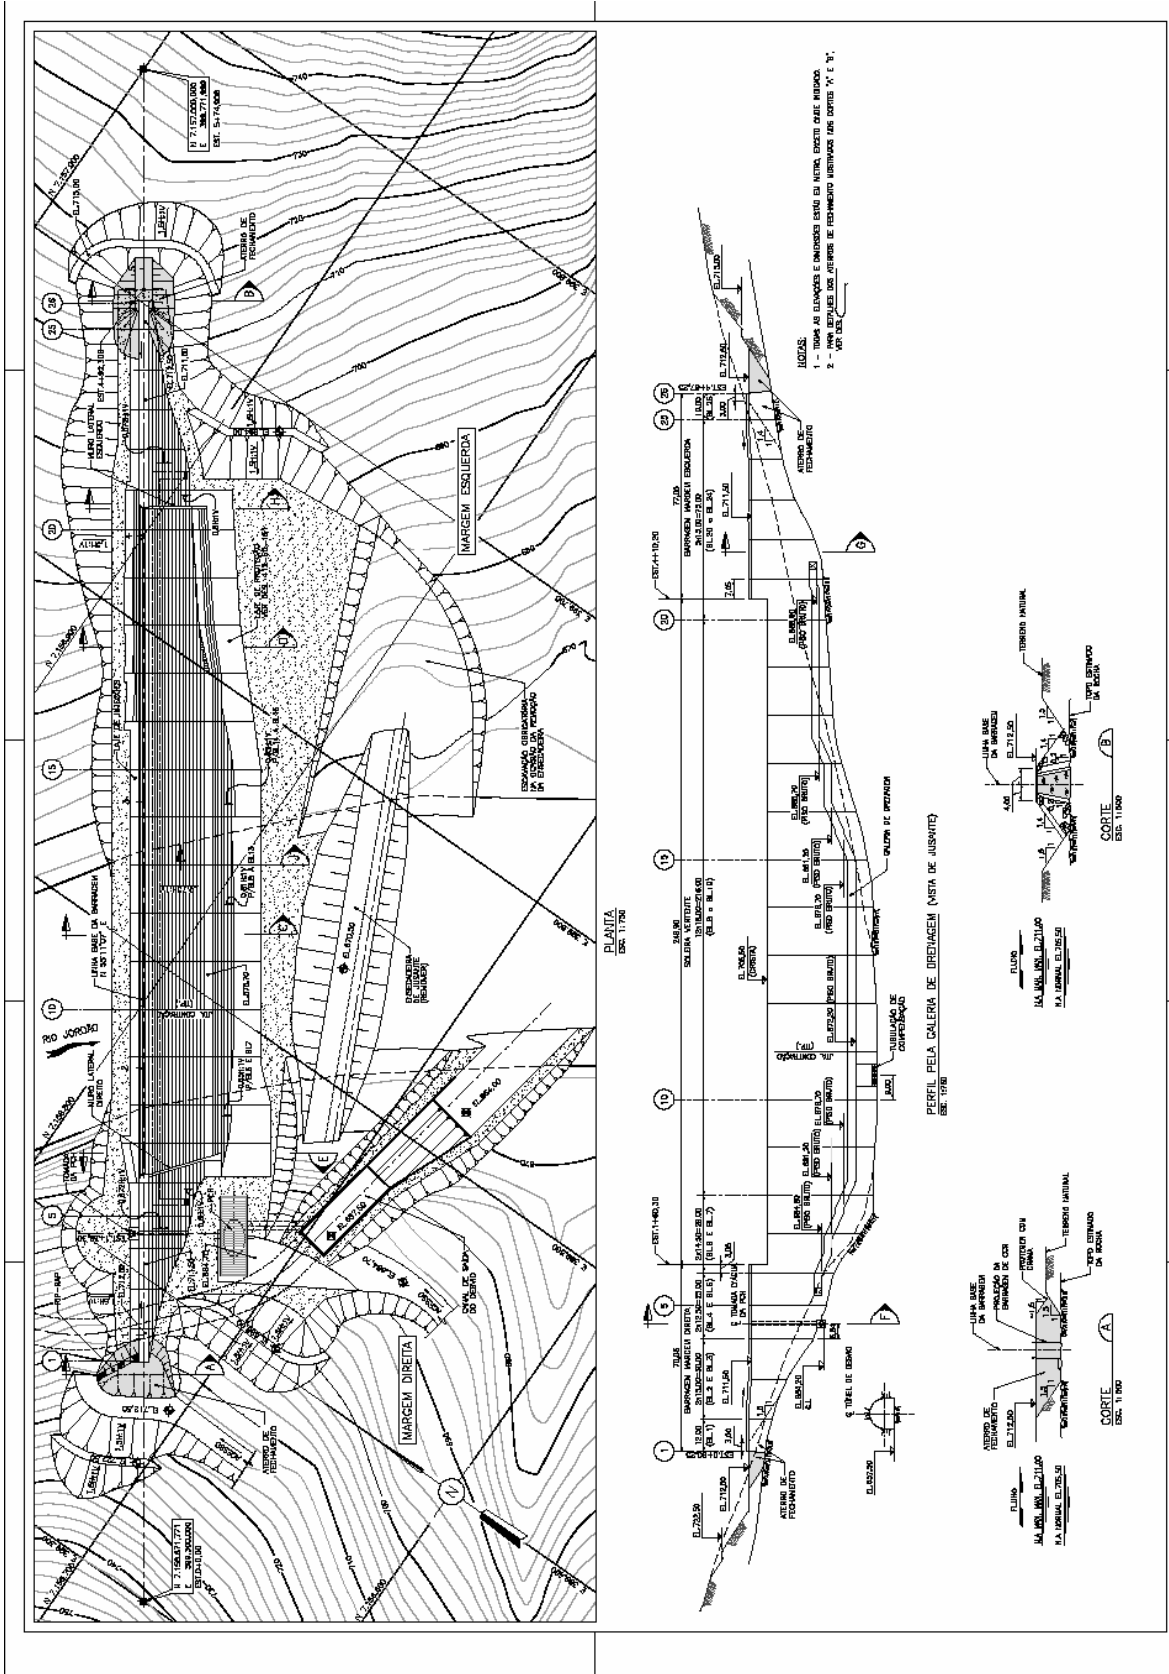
PLANTA E VISTA GERAL DA BARRAGEM DE UHE FUNDÃO - (FONTE: CADERNOS DE DESENHOS, PROJETISTA INTERTECHNE)
